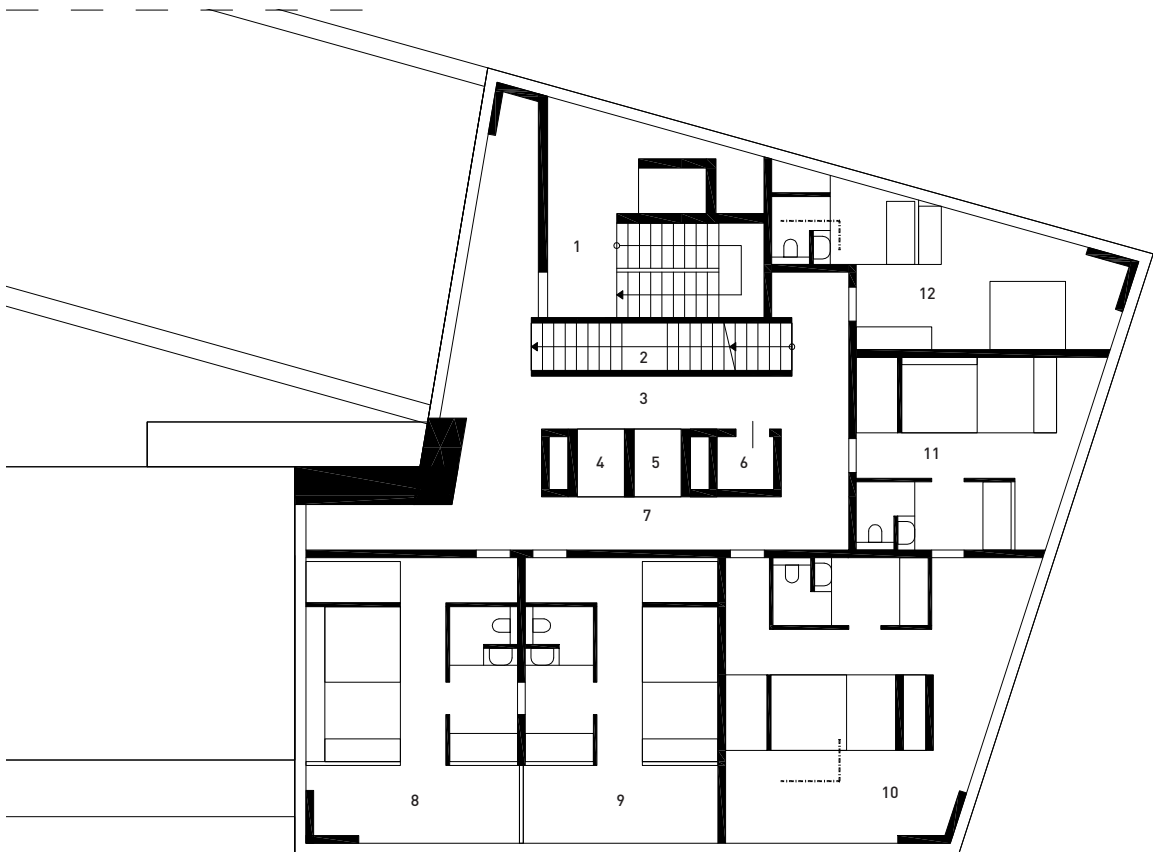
Grundriss Unterkunft Zimmer M1:200
